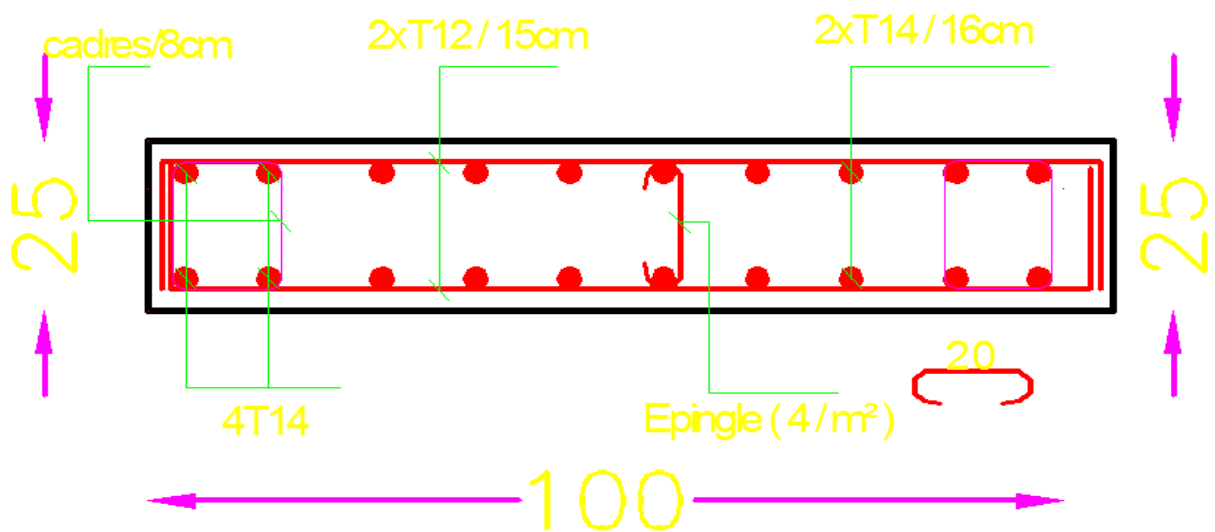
Ferrailage du Voile 1m zone III.
